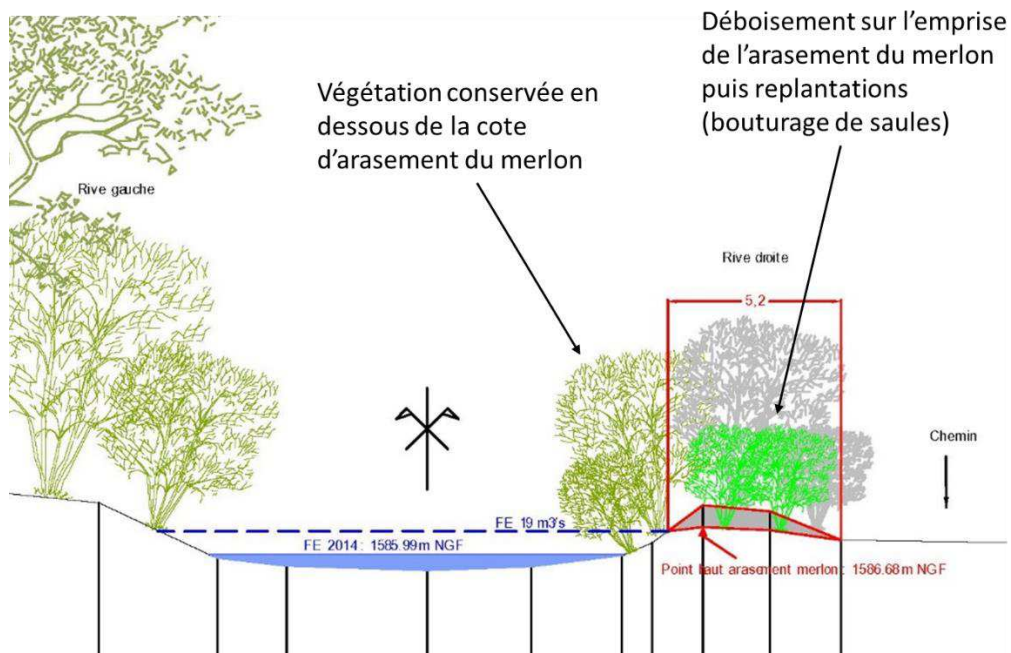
Détail du profil en travers 31 de l'arasement du merlon rive droite à Ville Basse
